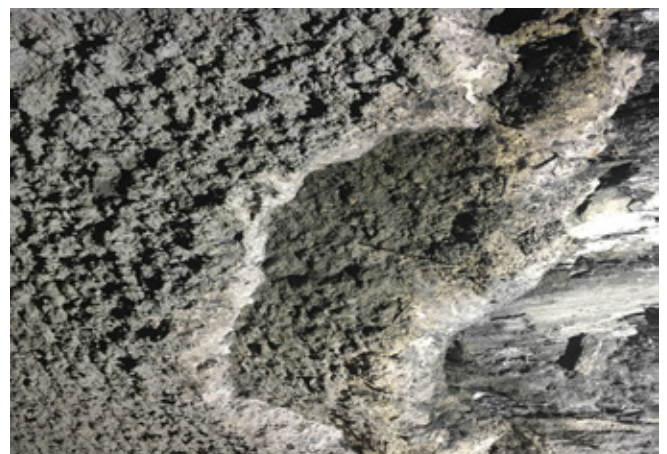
La mala preparación de la superficie impidió la adhesión entre las capas de concreto lanzado y el concreto con la roca
